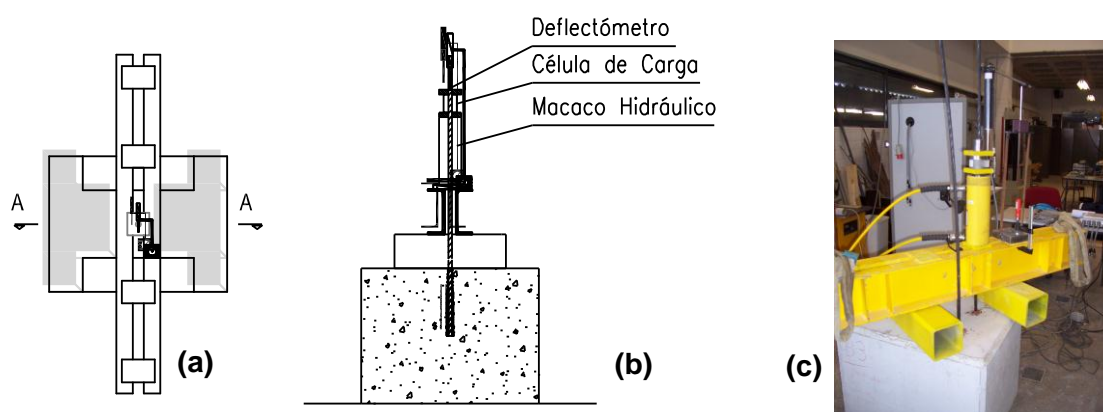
Localização em planta e em alçado da instrumentação inicial, (a) planta, (b) corte A-A e (c) vista geral.
